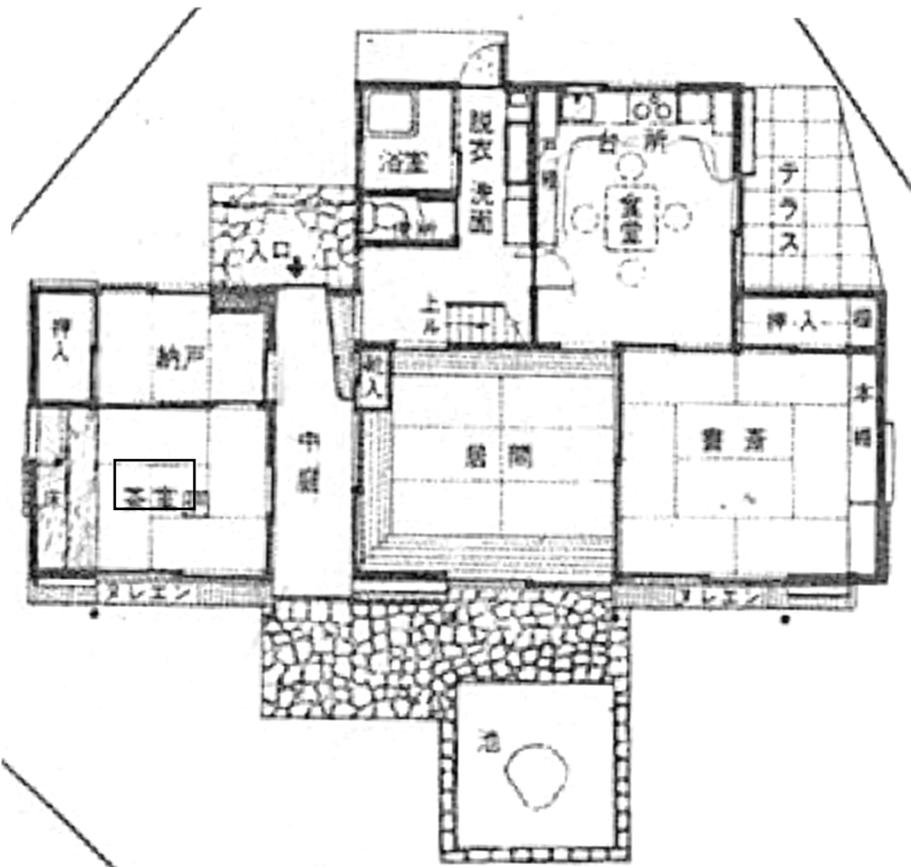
「吉永邸（通り庭のある家）」1階平面図
